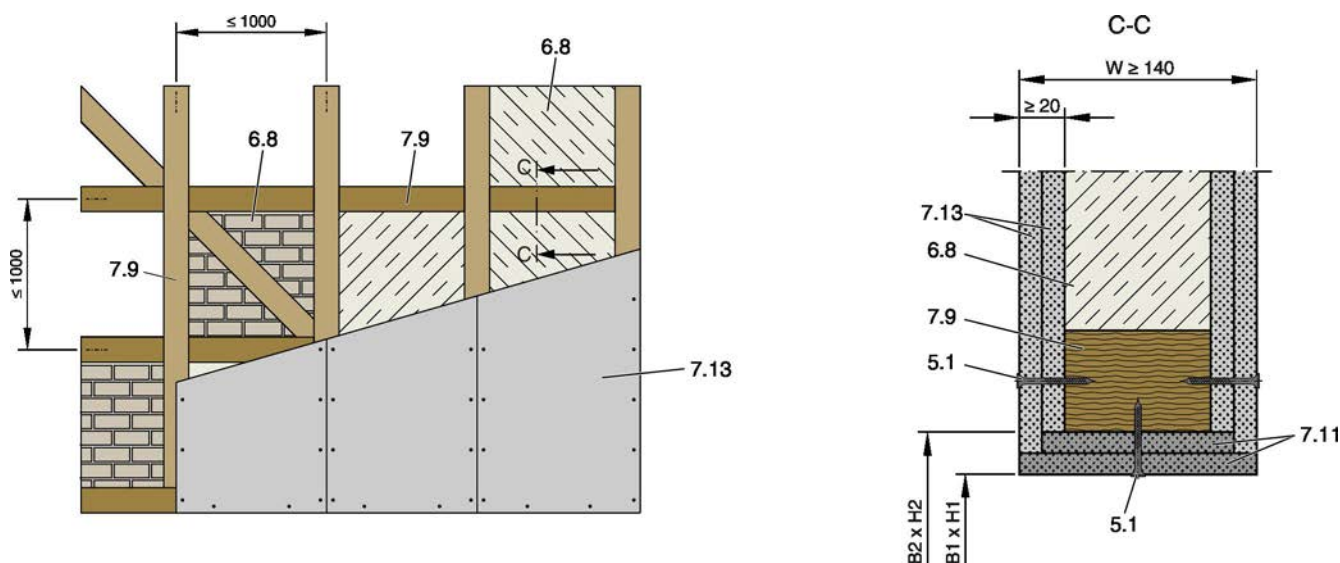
Lette skillevegger, bindingsverk med kledning på begge sider
